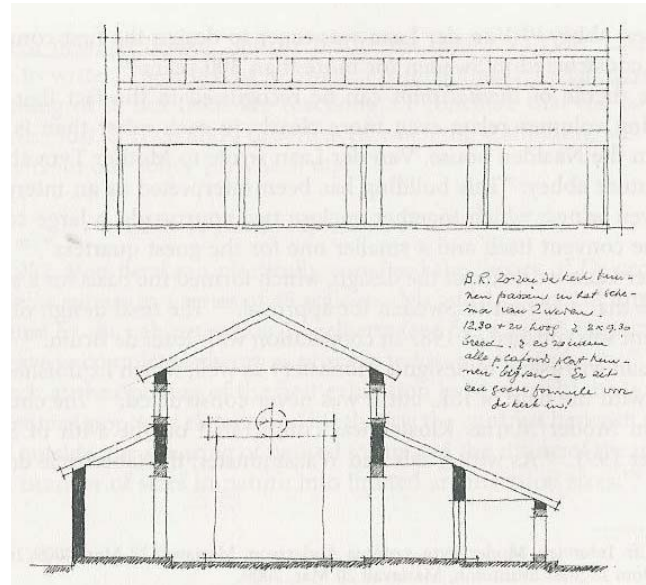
Prospetto e sezione della chiesa dell'abbazia
